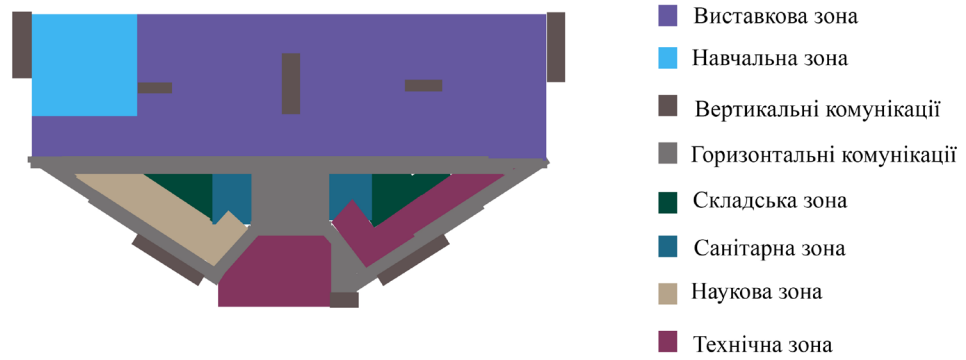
Схема функціонального зонування до плану на відмітці -4.200
